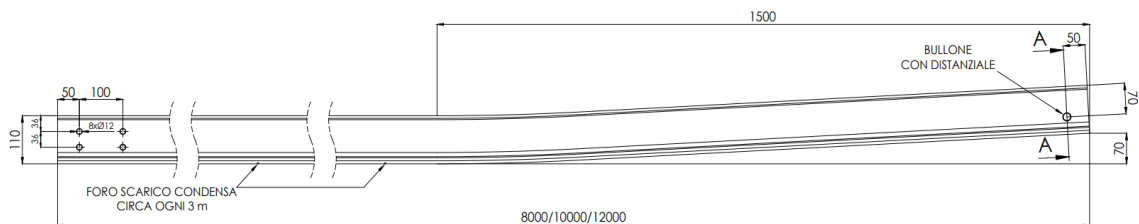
Vista longitudinale della catenaria rigida nel tratto di sovrapposizione tra le pezzature
